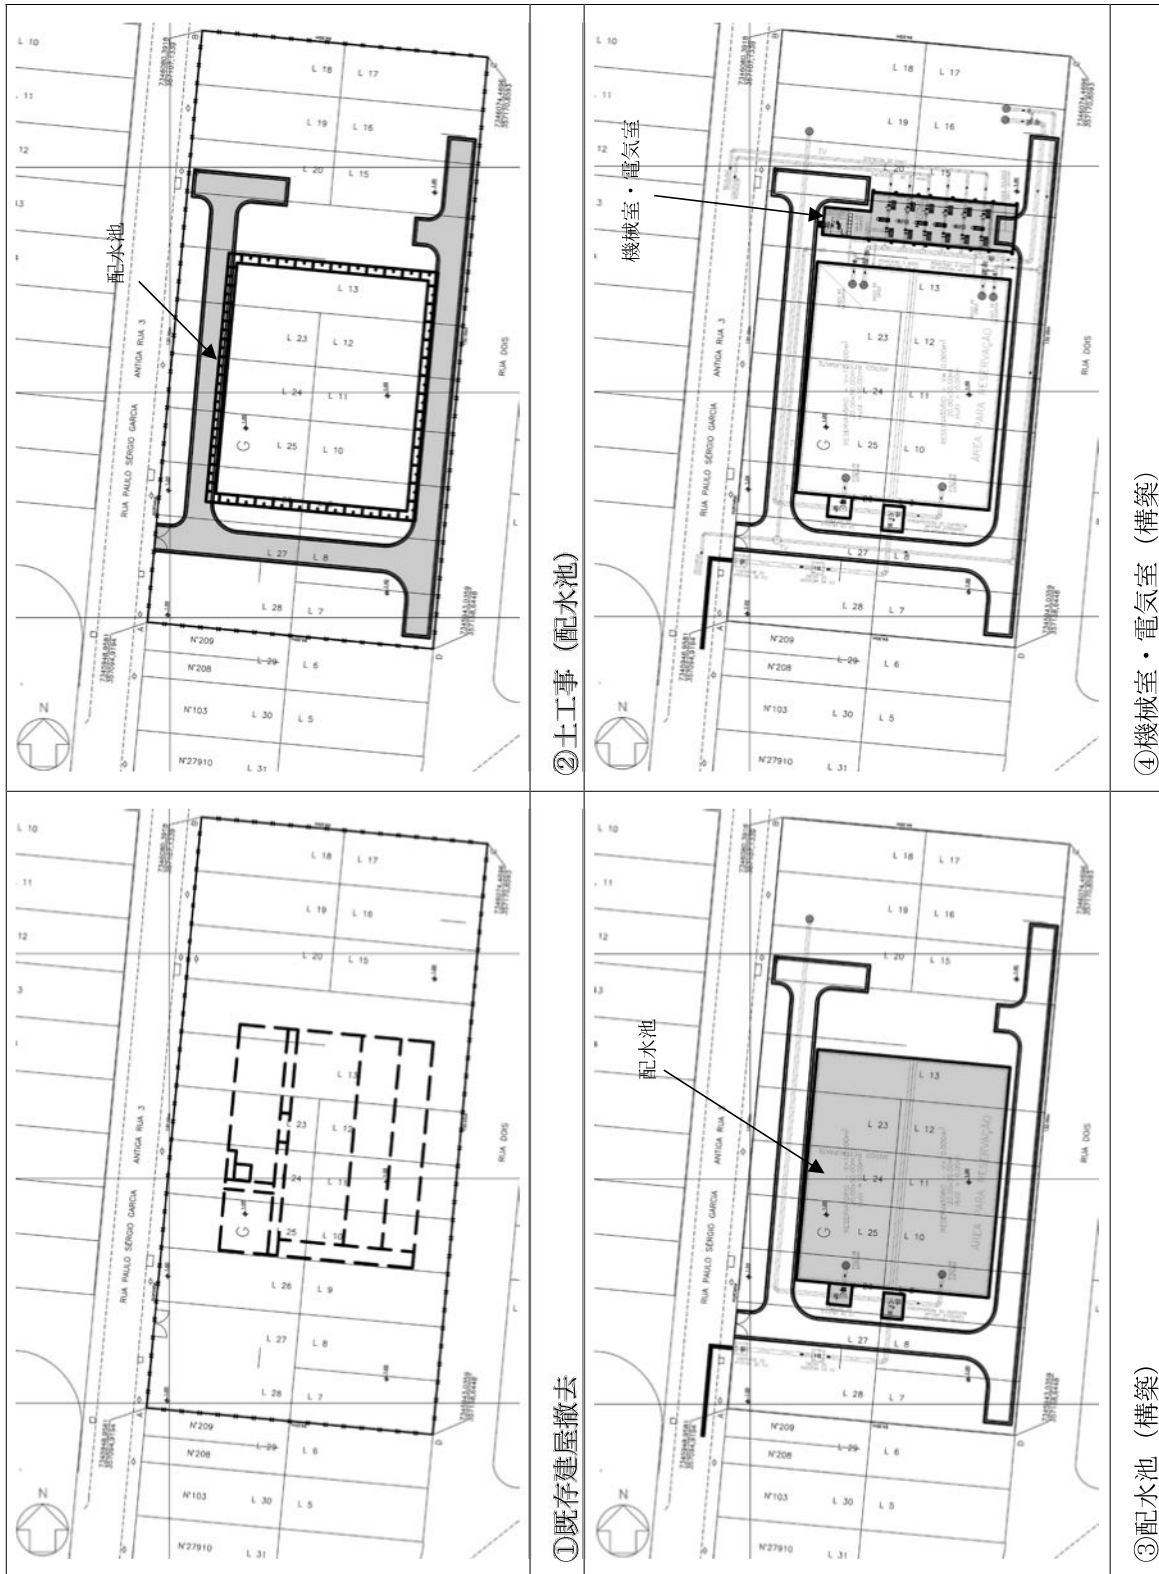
Vista Linda 処理場の施工ステップ(1/2)
